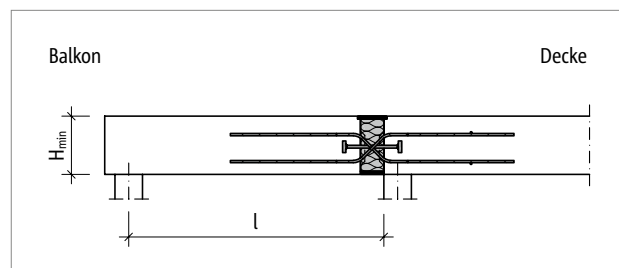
Schöck Isokorb® T Typ QP-VV: Statisches System
